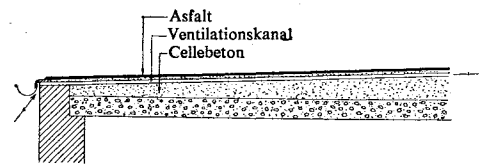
Jernbetontag med Afretningslag af porøs Beton.
